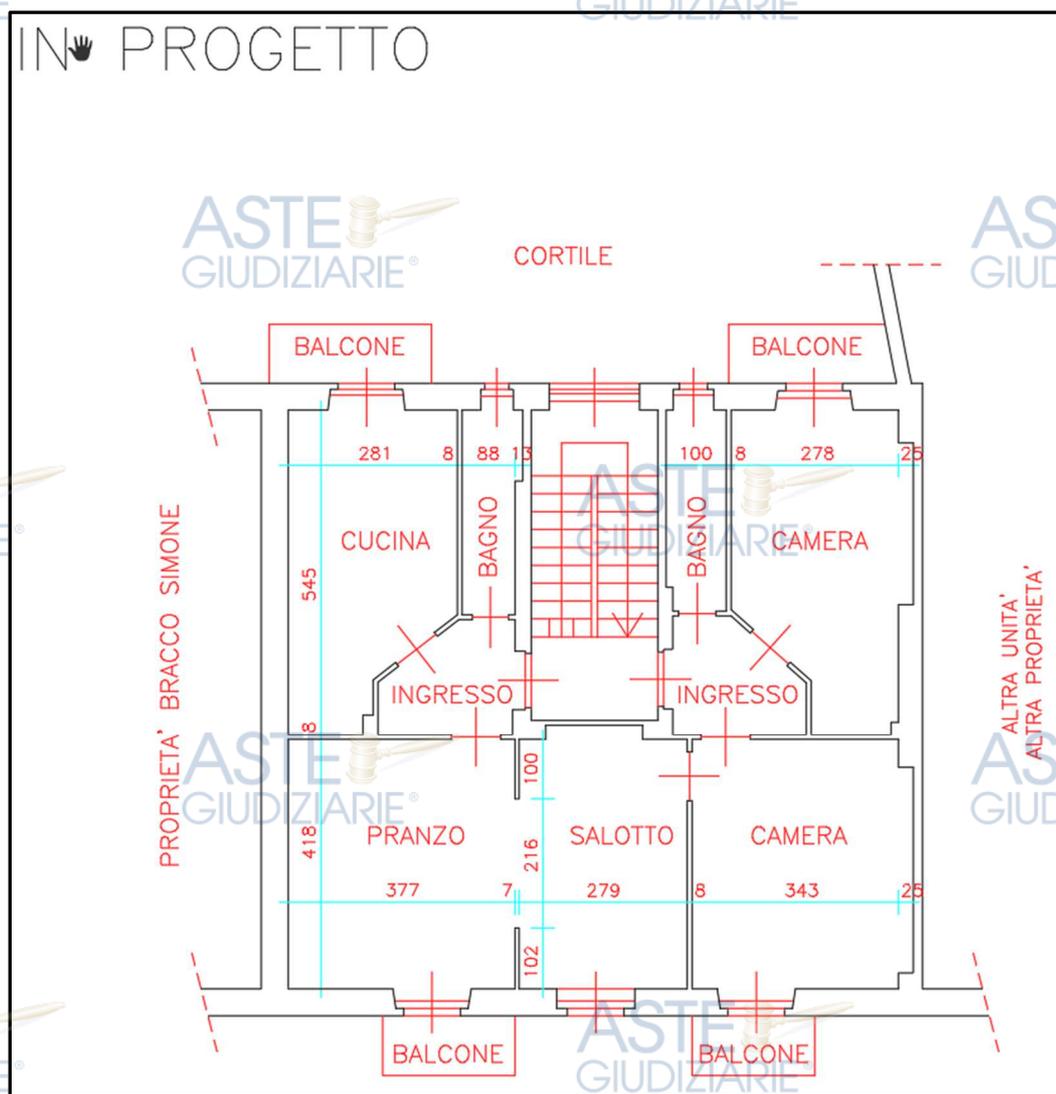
Estratto planimetria DIA prot. 2008_9_7990
